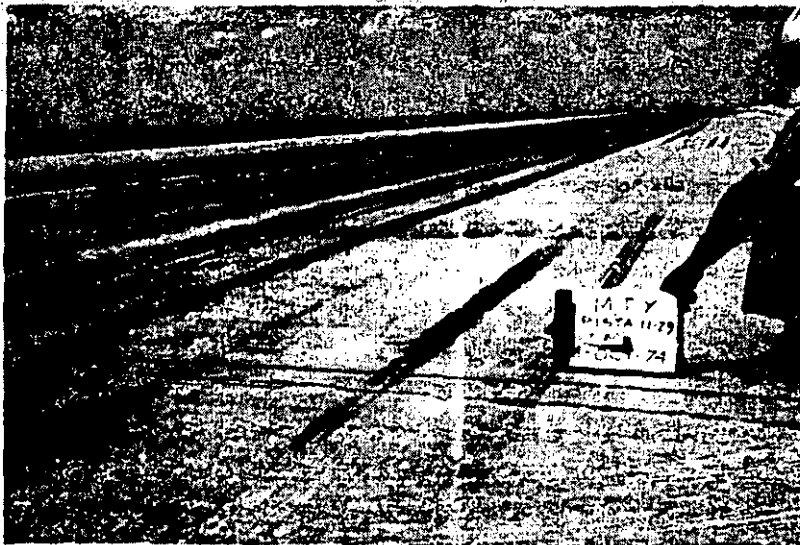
Otro muestra de grieta provocada por aserramiento tardío
